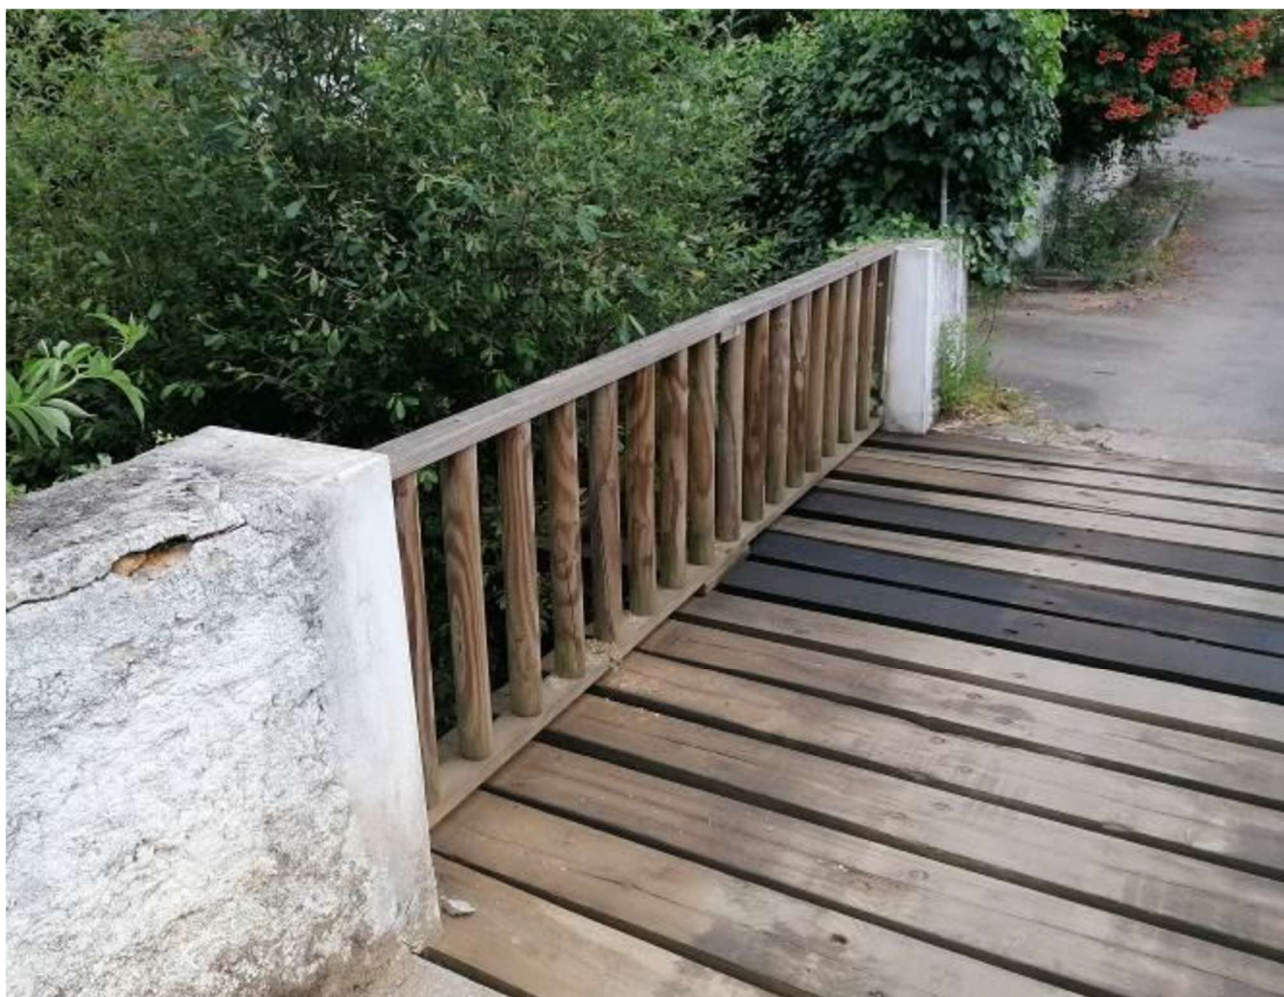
Ponte de madeira existente na ligação da Rua do Soito
